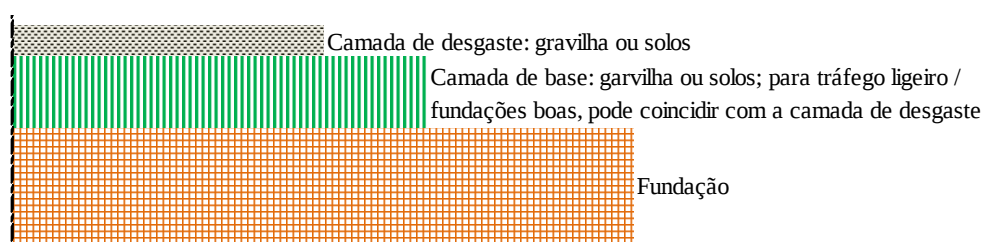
Estrutura do pavimento de estradas não revestidas (adaptado de Fortunato et al, 2013)
